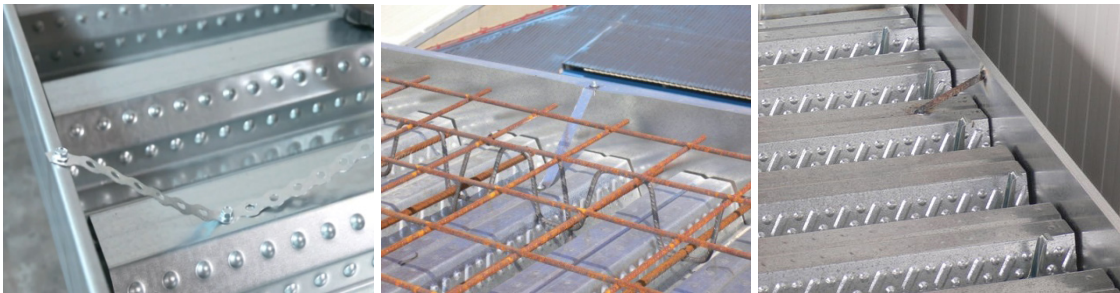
Примеры крепления торцевой планки сталежелезобетонной плиты
